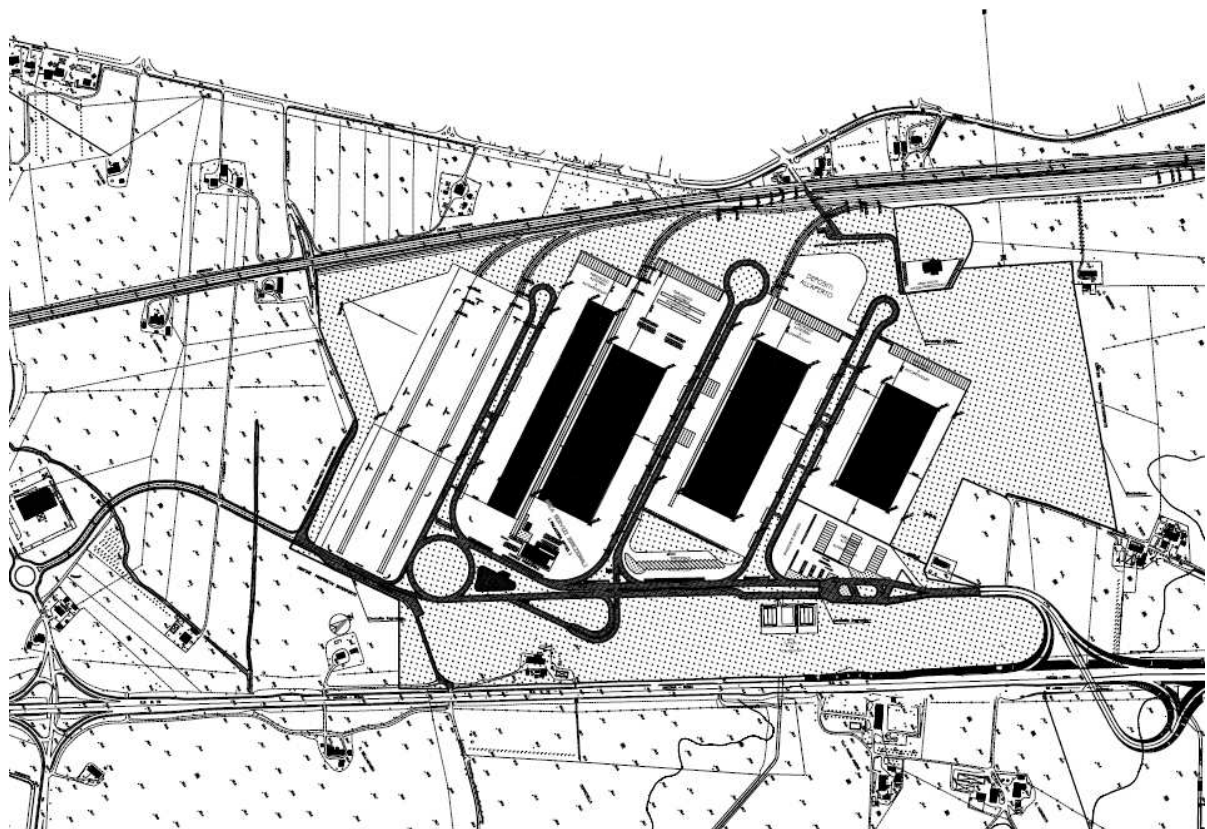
planimetria dell'infrastruttura interportuale di Jesi
